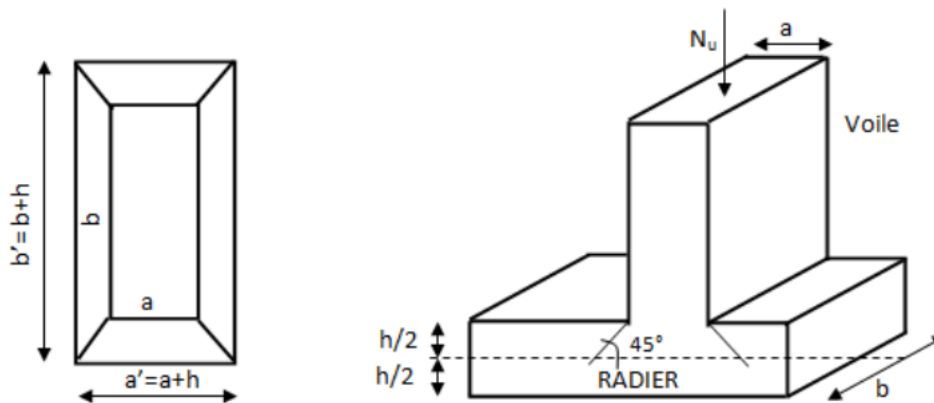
Périmètre utile des voiles et des poteaux.
